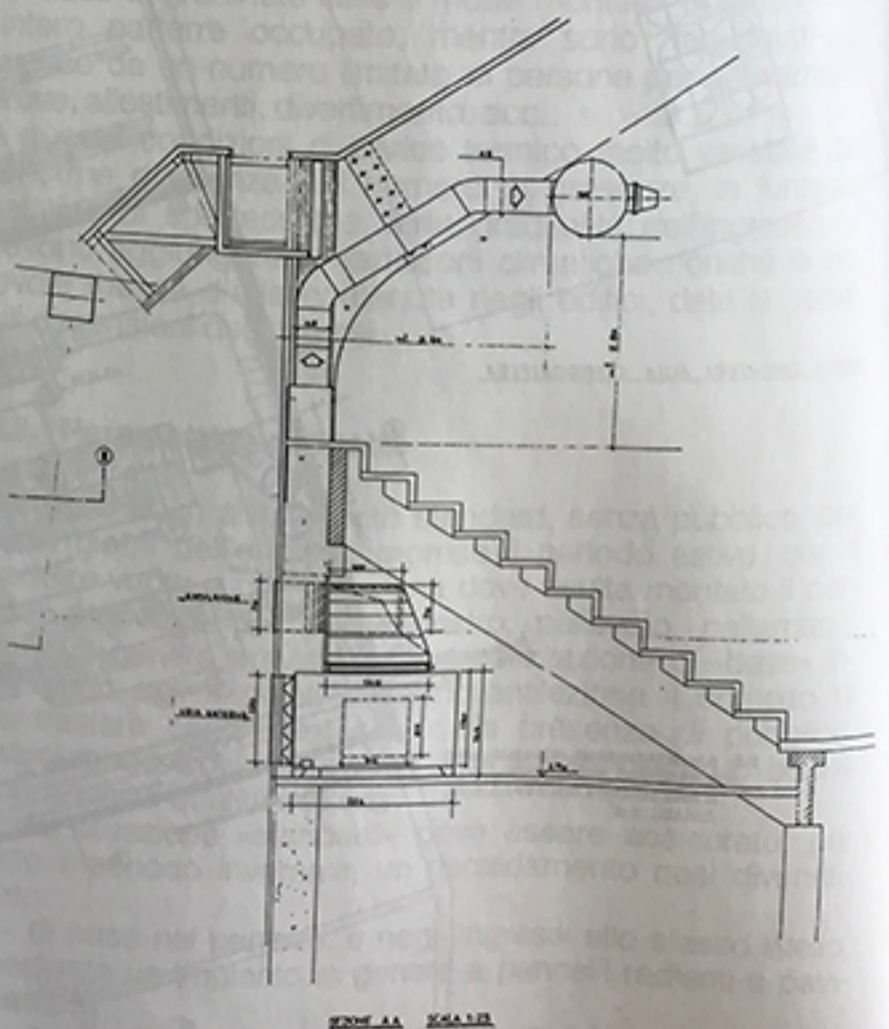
Particolare della disposizione in sezione della UTA e dei canali di collegamento all'ugello di immissione dell'aria.
